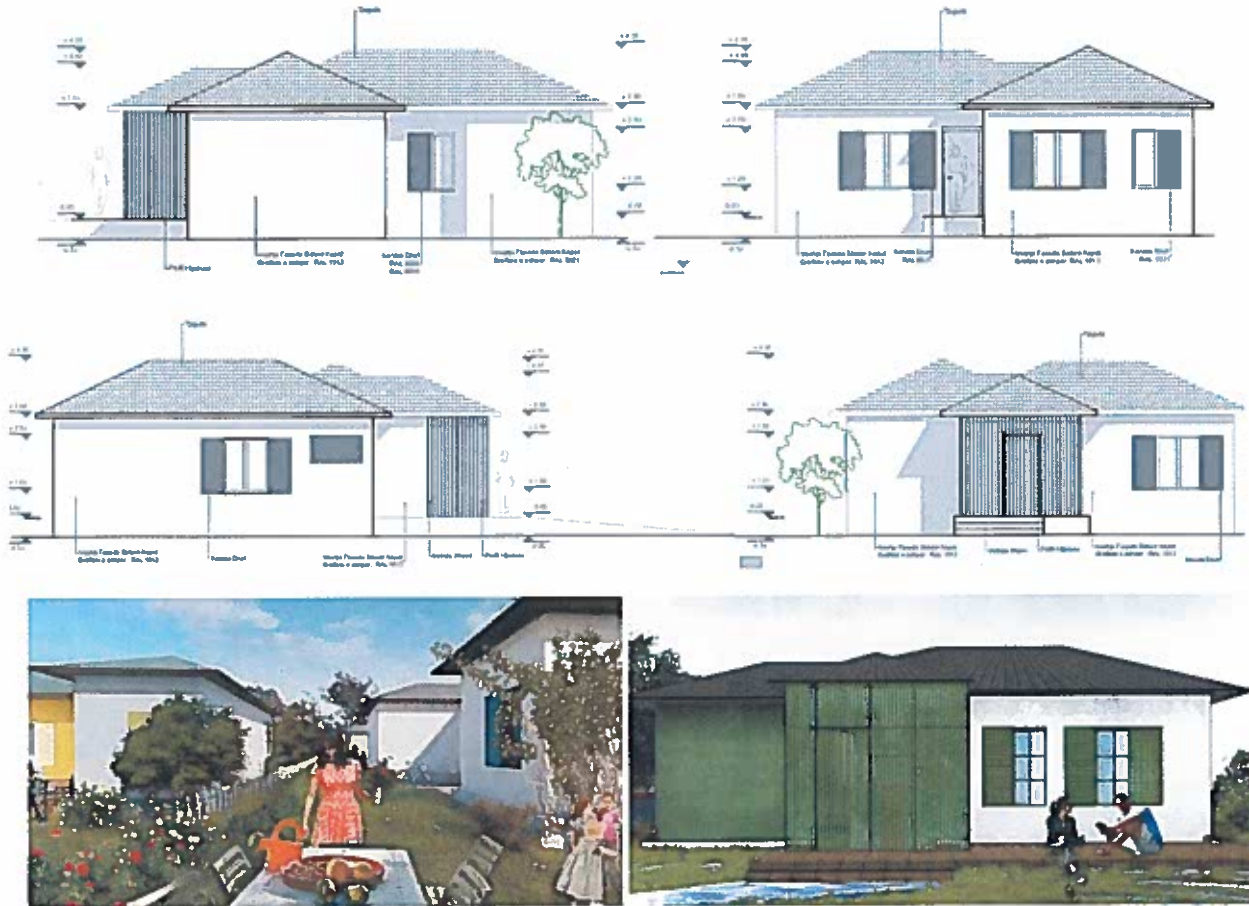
Planimetri dhe Prerje te Baneses 3+1 (105.1 m2)
